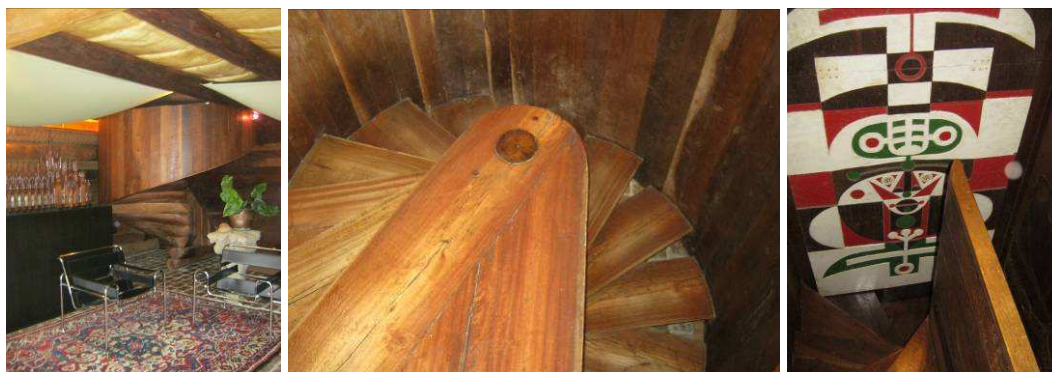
Escadas de acesso pavimento superior: escada principal e de serviços.
